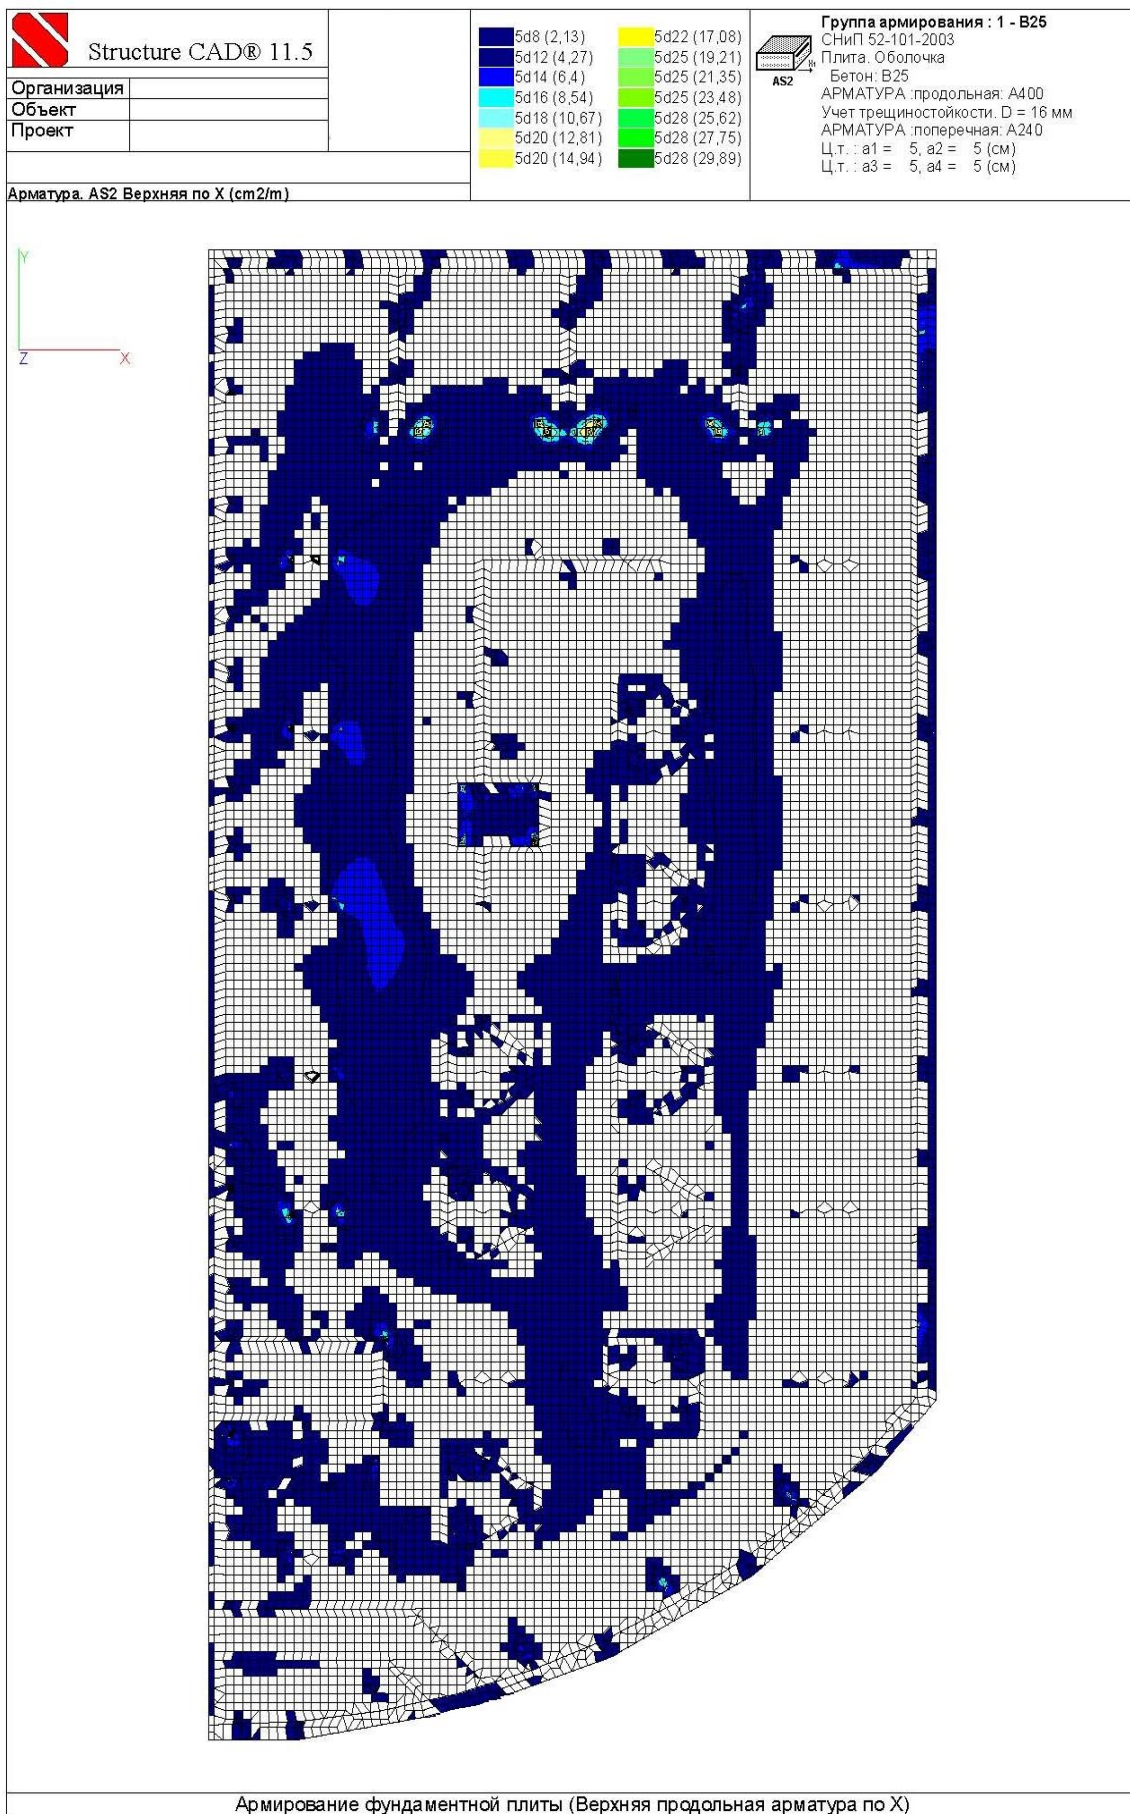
Верхнее продольное армирование фундаментной плиты по оси X
